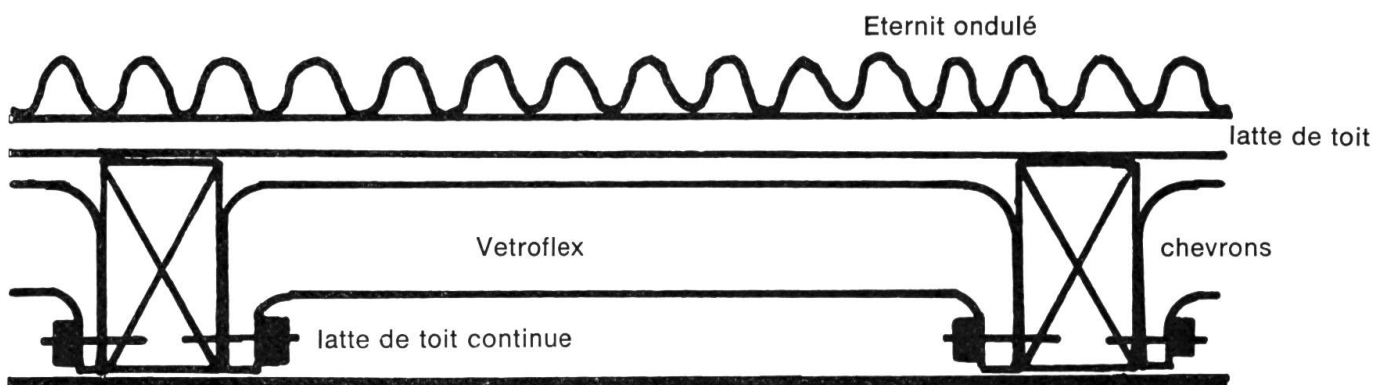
Isolation du toit bien faite. Elle est étanche car elle est fixée par la latte de toit continue et ensuite, clouée.
